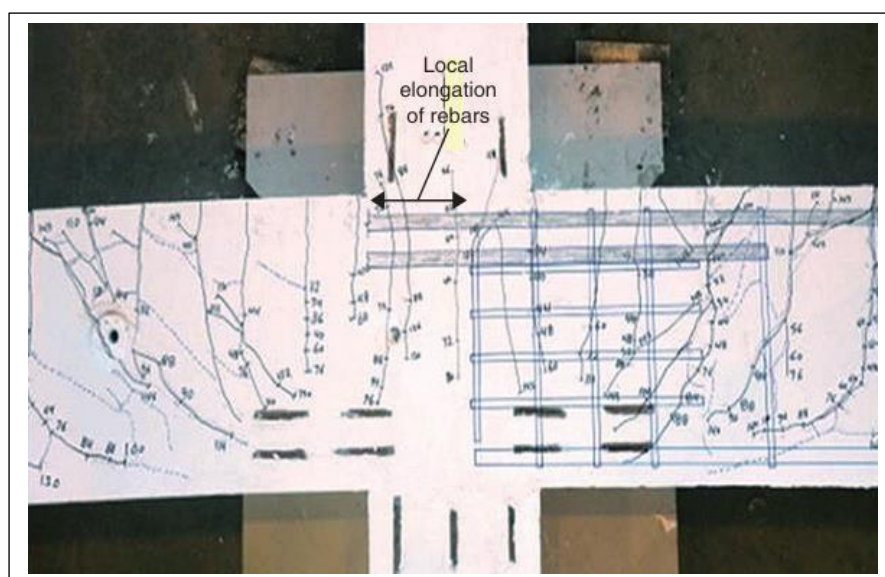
Fissuration en flexion dans les connexions poutre–poteau cruciformes en béton préfabriqué [36].
